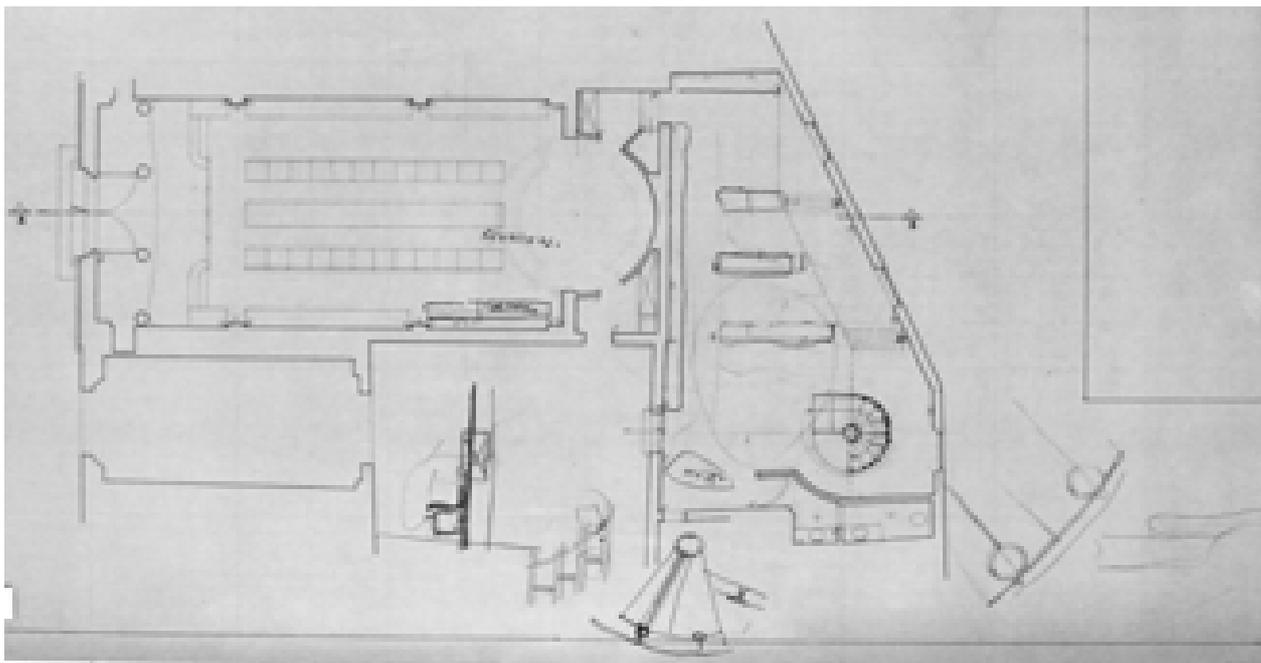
San Leonardo studio planimetria - s.d. (AABS-94.099)
